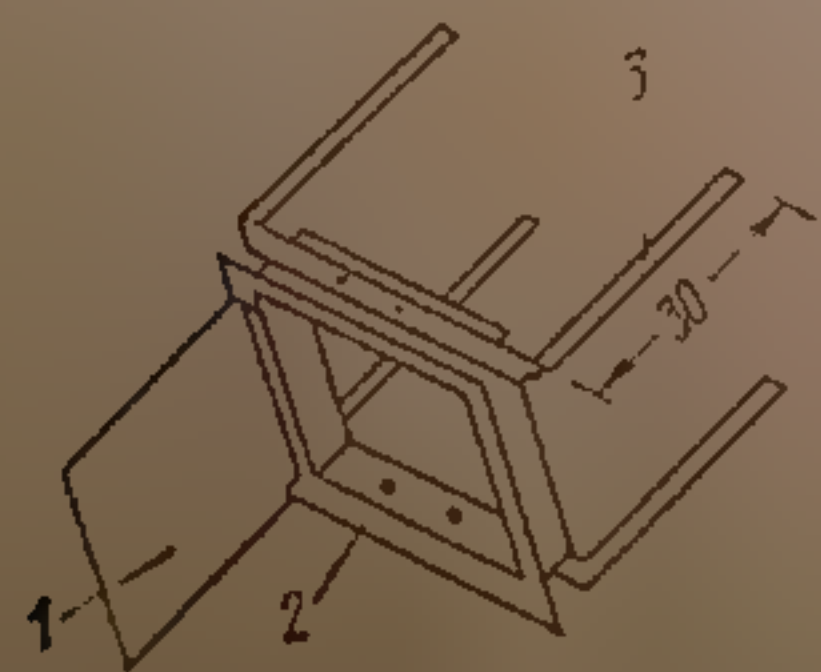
Крепление кламмеров к рамке топочной дверки: 1 — дверка; 2 — рамка; 3 — кламмеры
